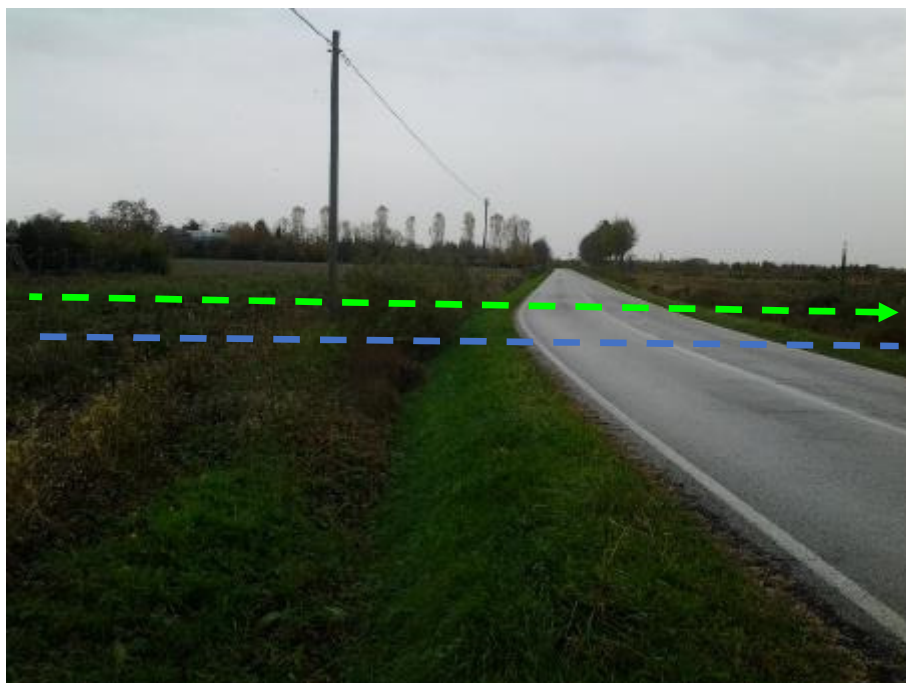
ATTRAVERSAMENTO S.P. N.73
